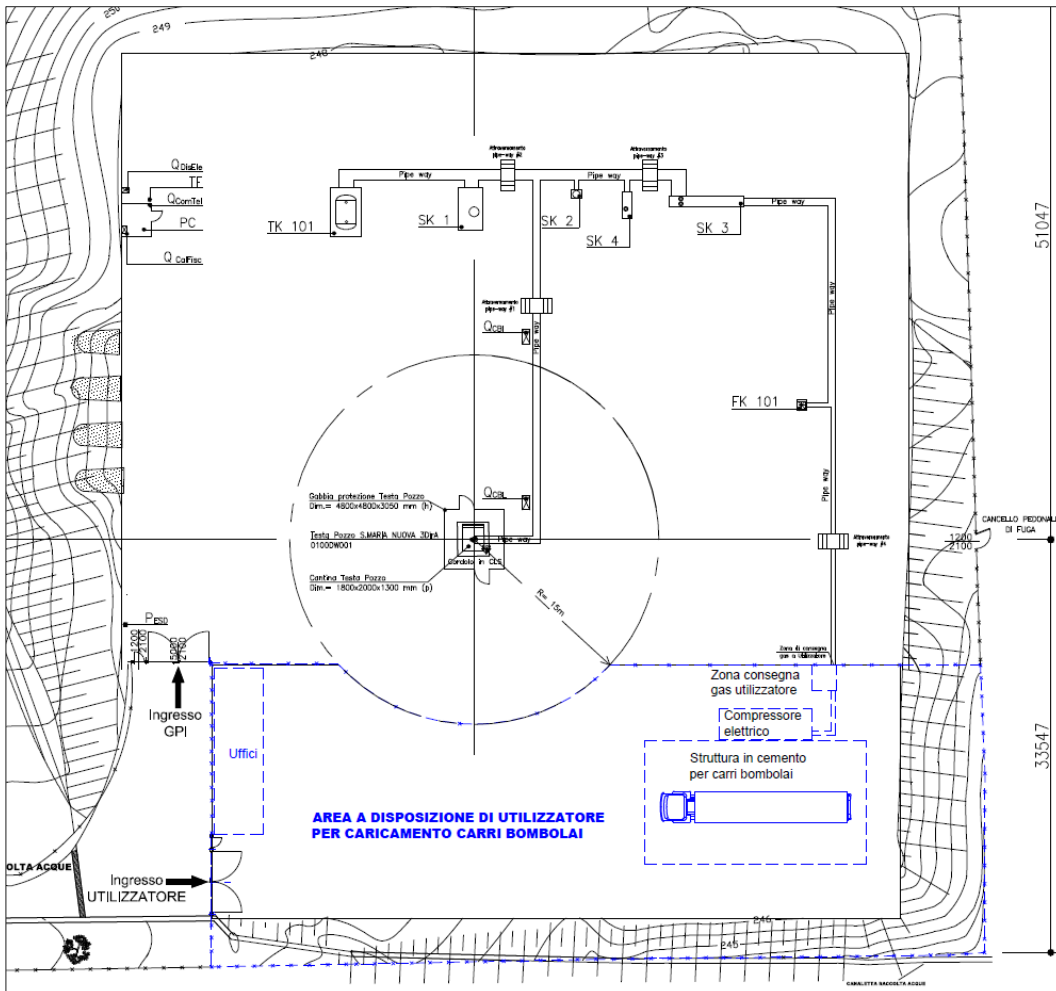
stralcio del layout dello stato di progetto (Tavola 3) con l'indicazione degli impianti dell'area SMN 3.
